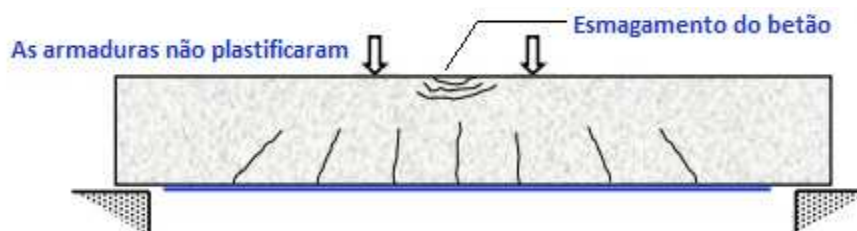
Esmagamento do betão sem plastificação das armaduras ordinárias [adaptado de 52]
